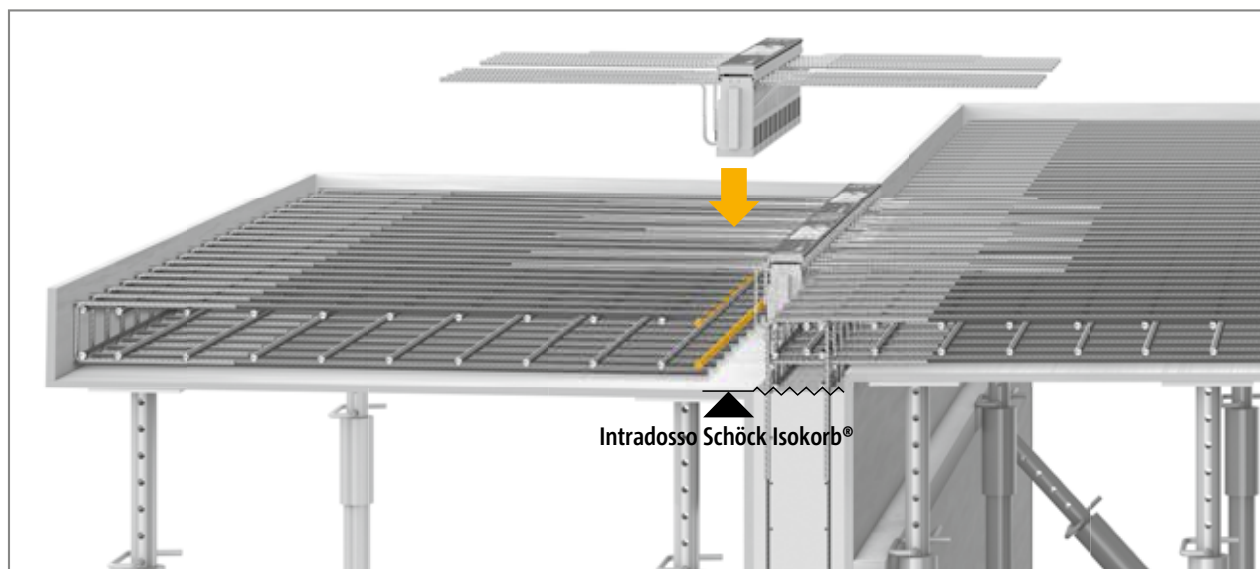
Schöck Isokorb® T tipo KL: posa dell'armatura ed installazione di Schöck Isokorb® T tipo KL
